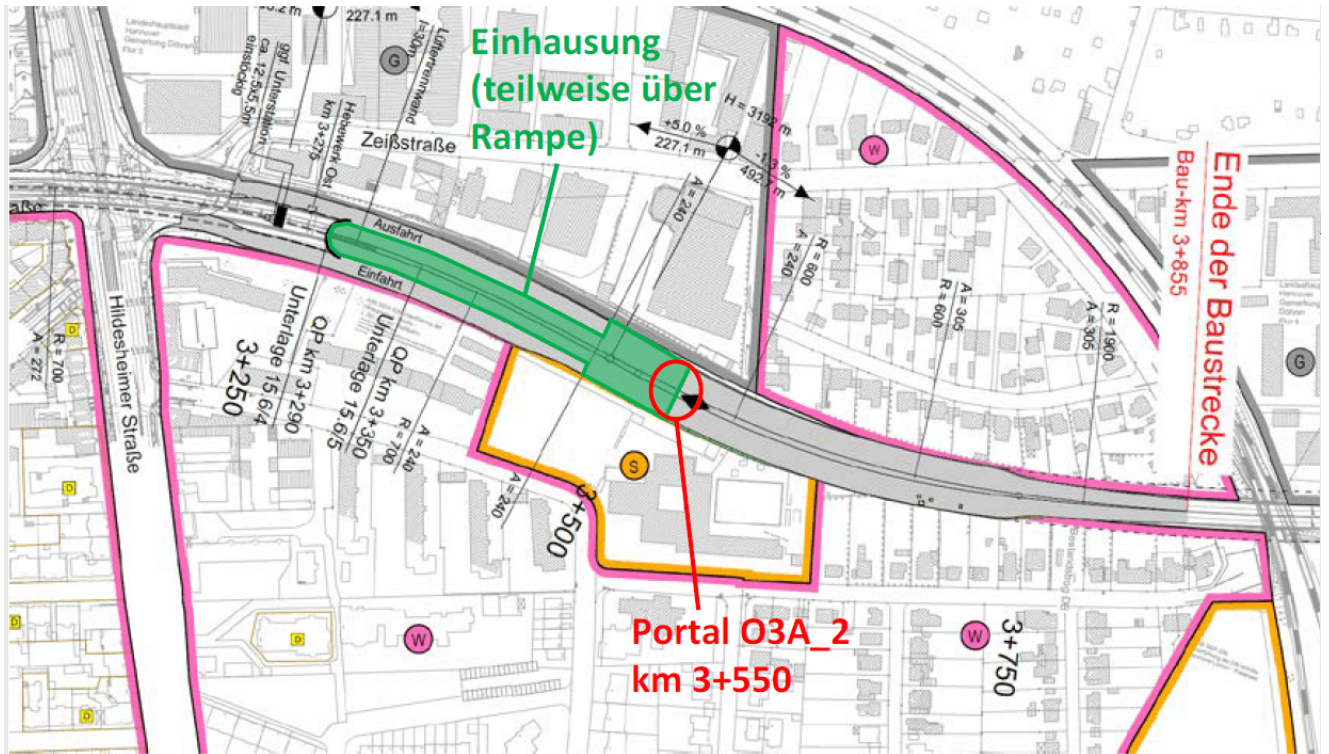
Lageplanskizze Planvariante O3A_2 [20].
